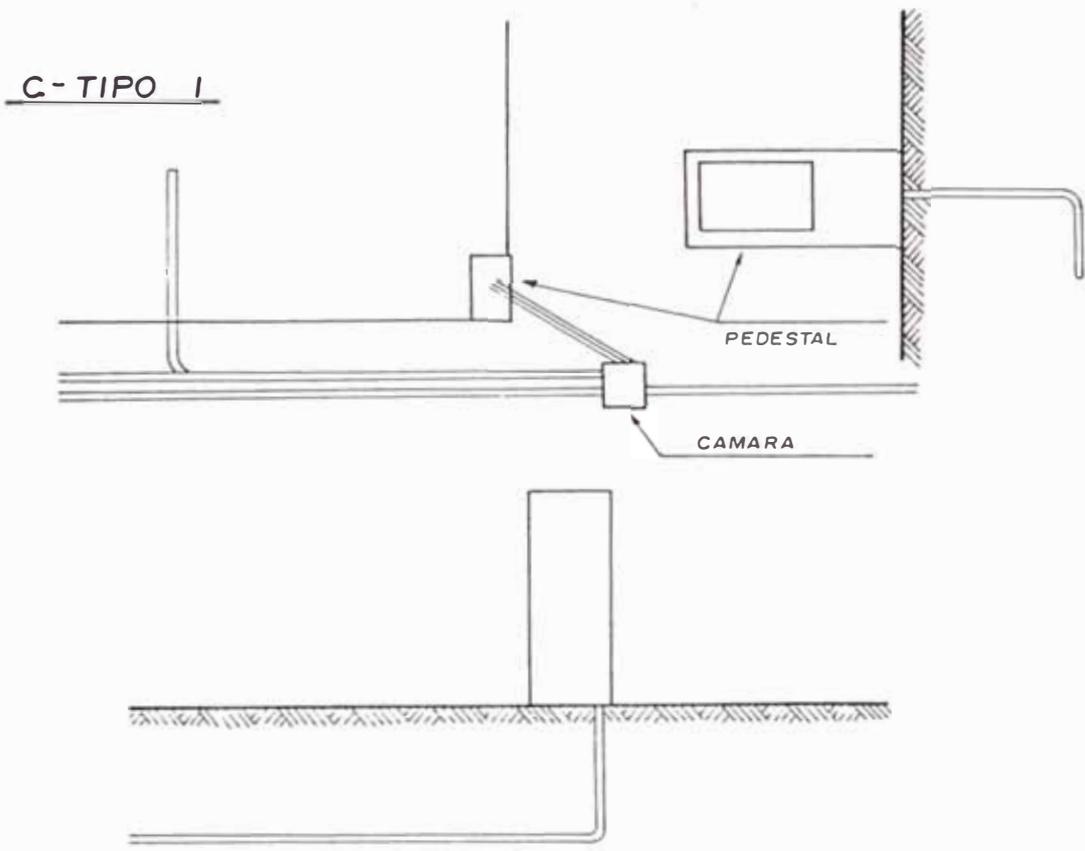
FIG.V-II.- DETALLE DE CONSTRUCCION DE CANALIZACION - CAMARAS
